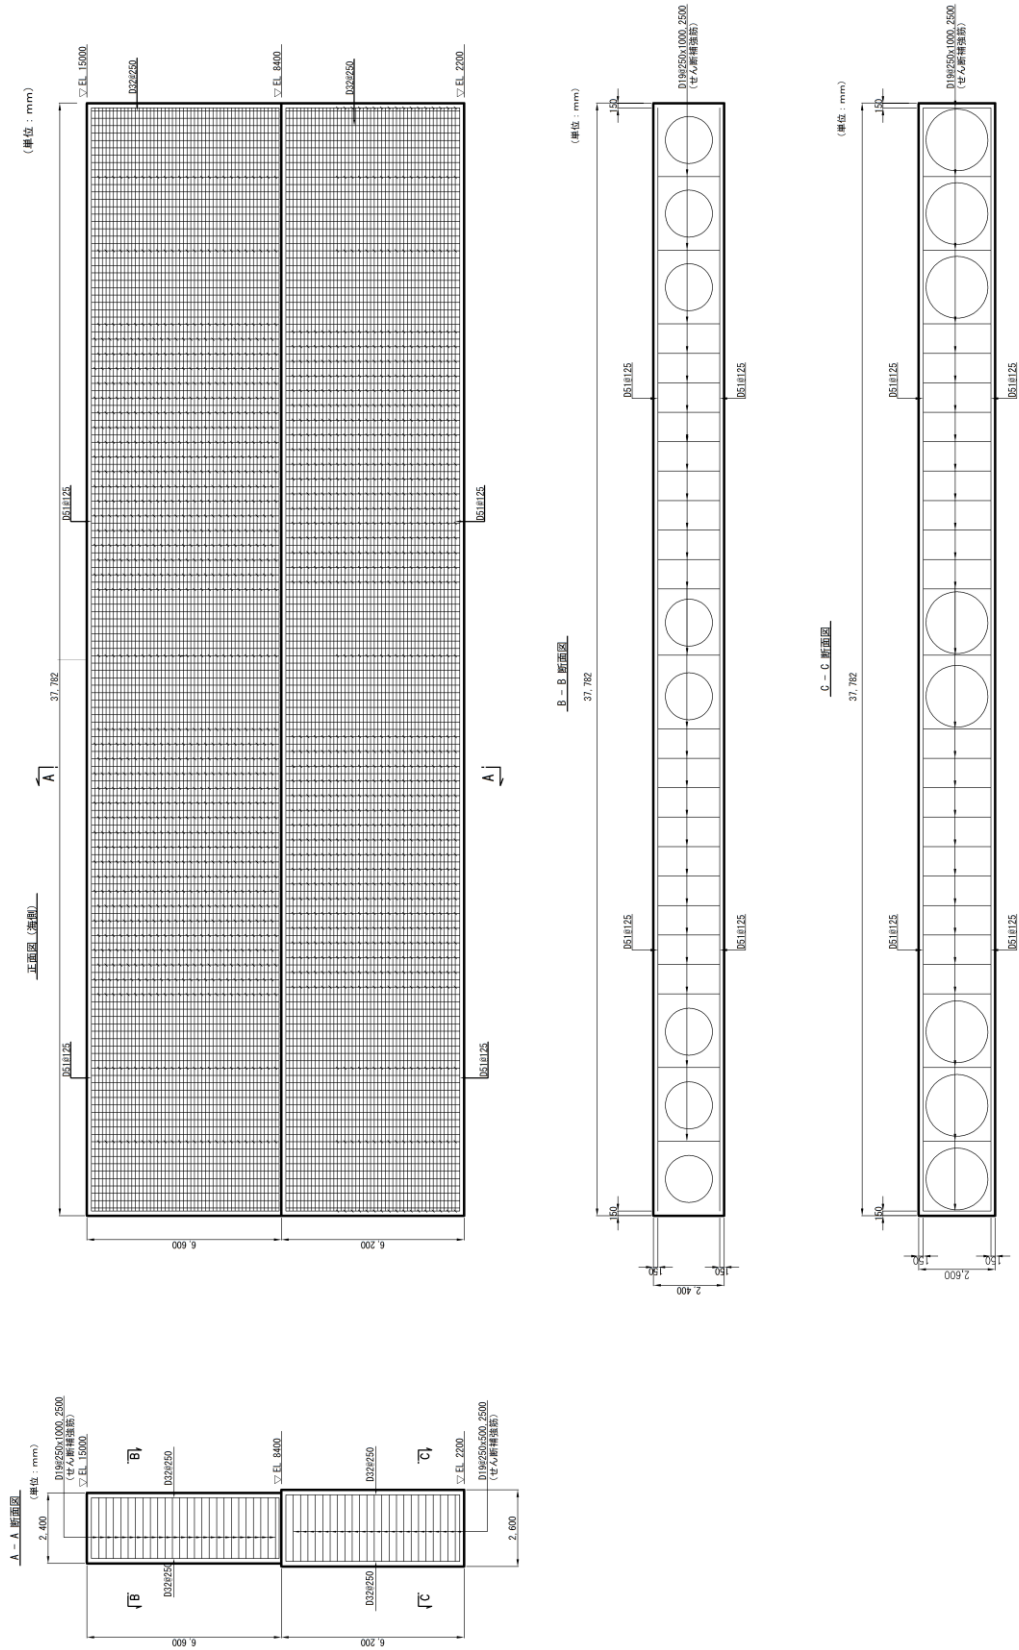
被覆コンクリート壁の概略配筋図 (④-④断面)
